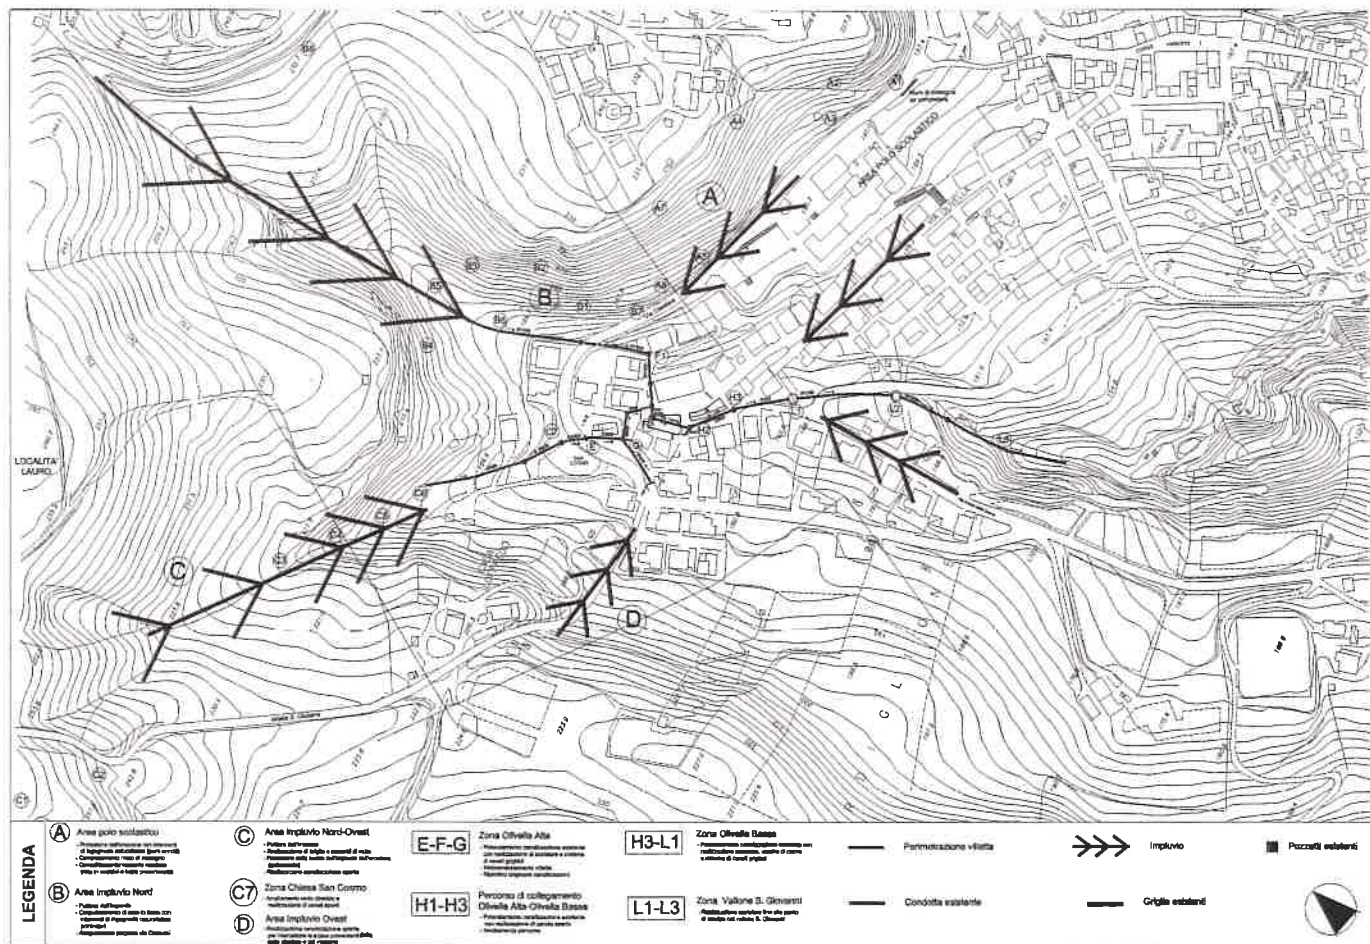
Planimetria generale con indicazione delle canalizzazioni esistenti e delle aree di intervento
